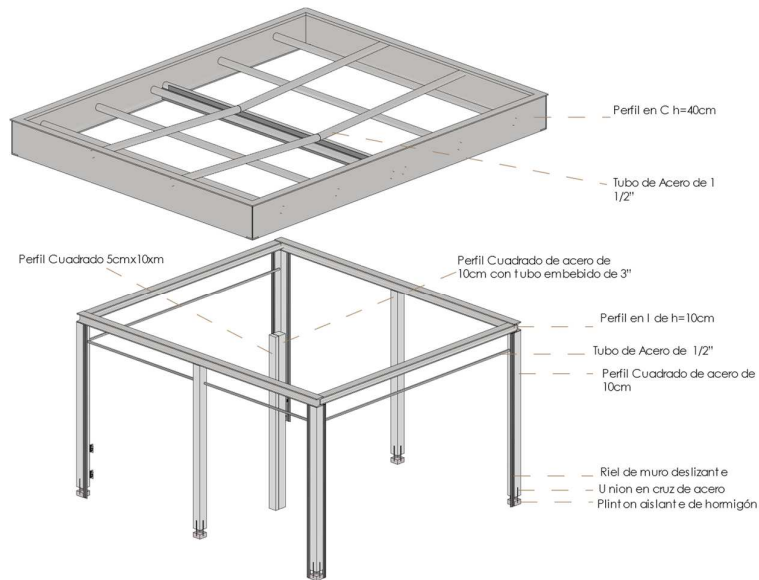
Armado Estructural fuente: propia elaboración: William Marquez
